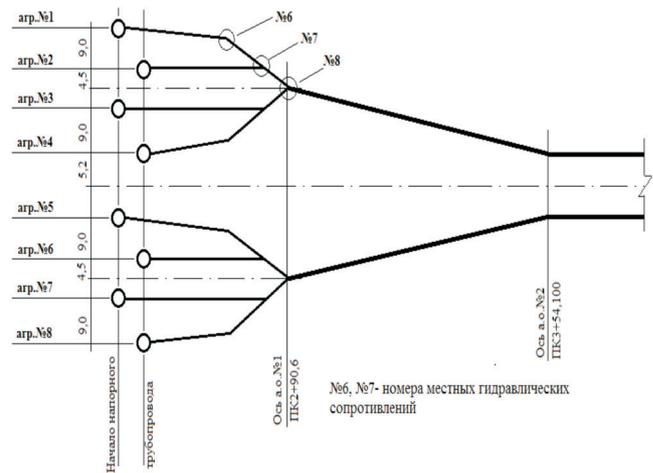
Схема плана начального участка напорного трубопровода насосной станции «Бабатаг».
